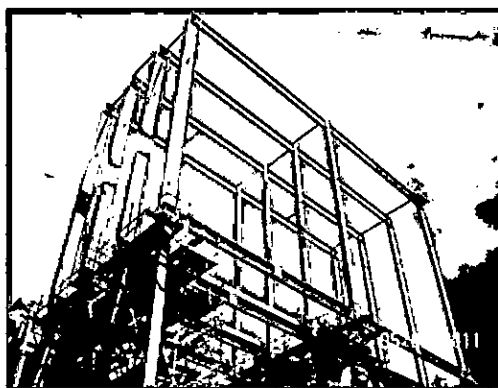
Avance de montaje mecánico de las estructuras del Equipo Electrofiltro
